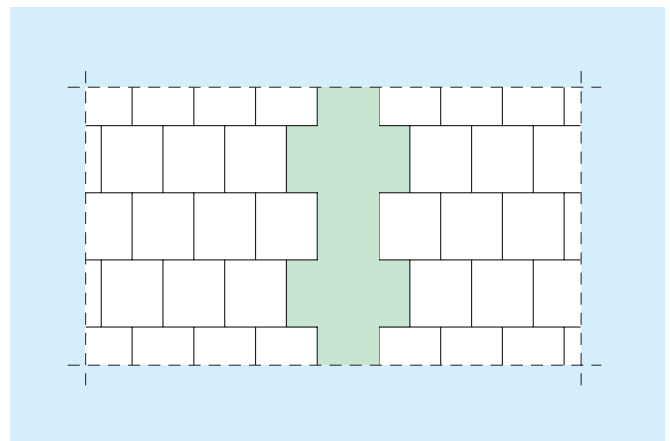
Rissrisiko beim nachträglichen Betonieren von Stahlbetonstützen im Verband mit Mauerwerk
